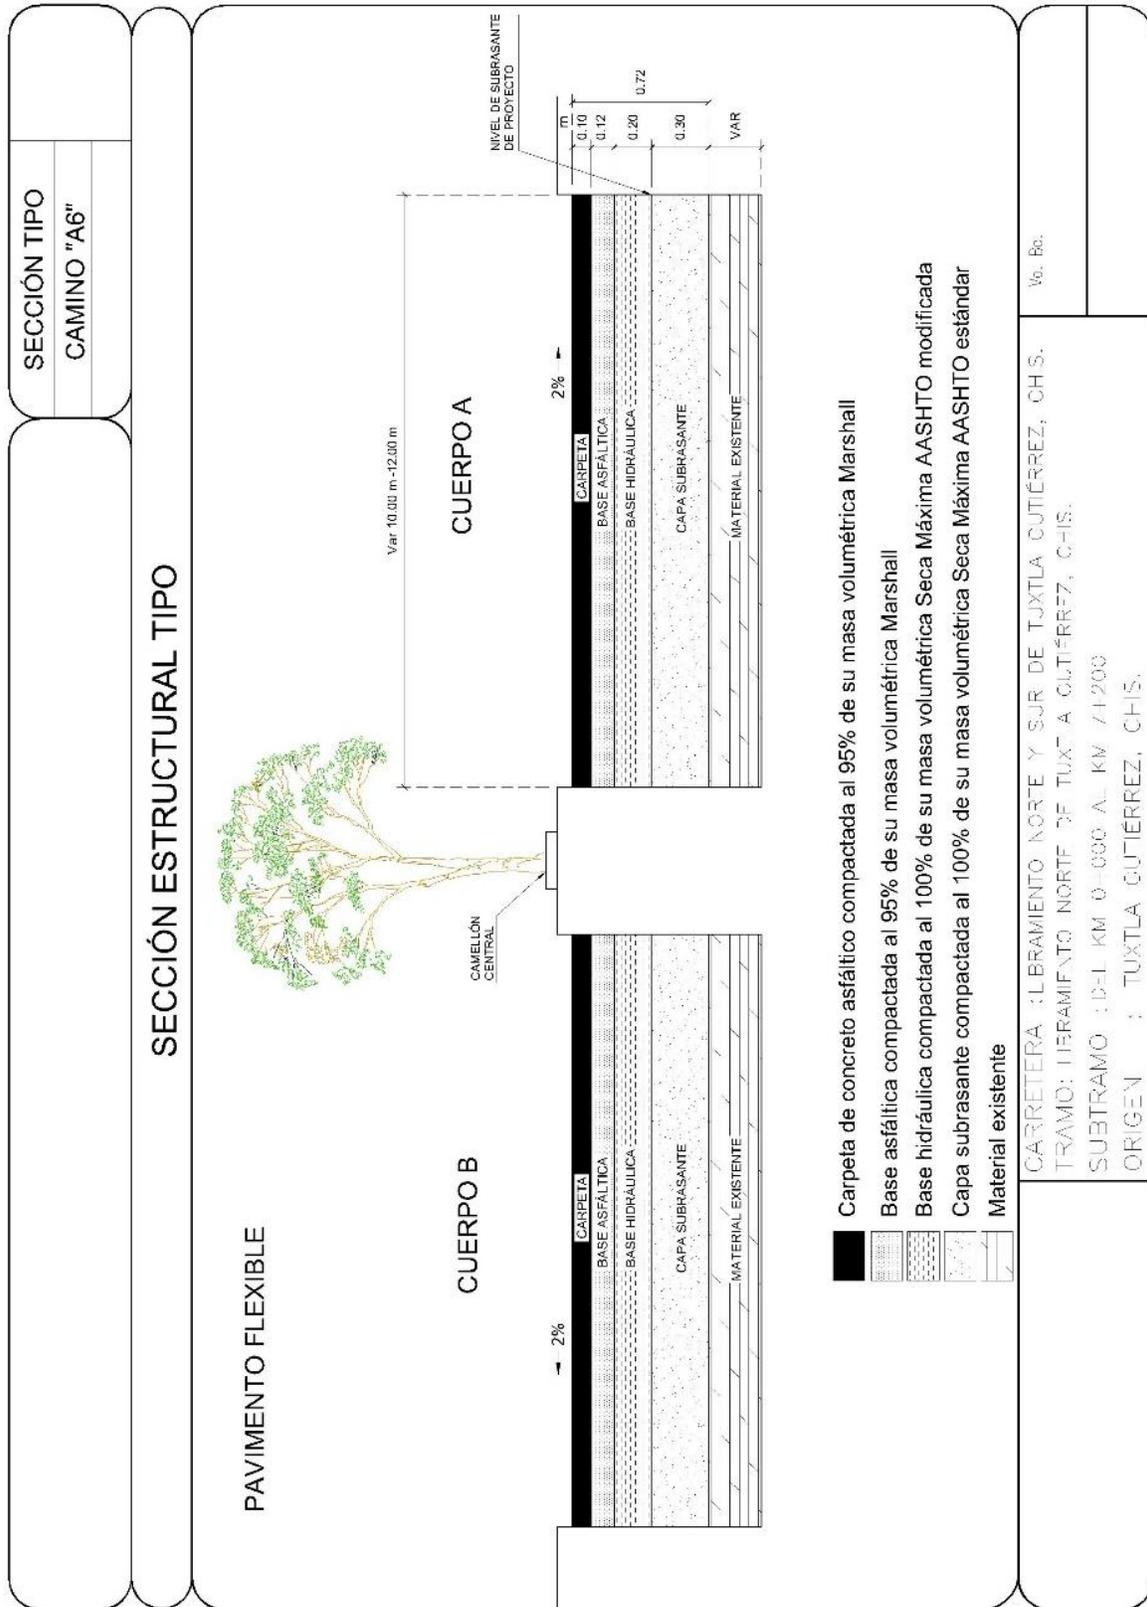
Sección estructural definitiva del pavimento.
